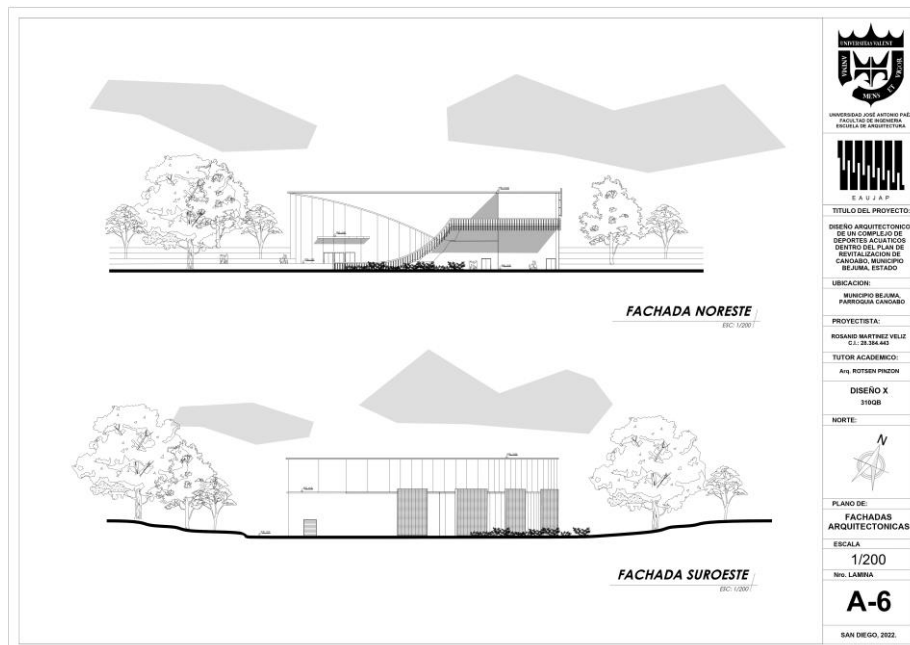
Fachadas Arquitectónicas. Fuente: La autora (2022).
